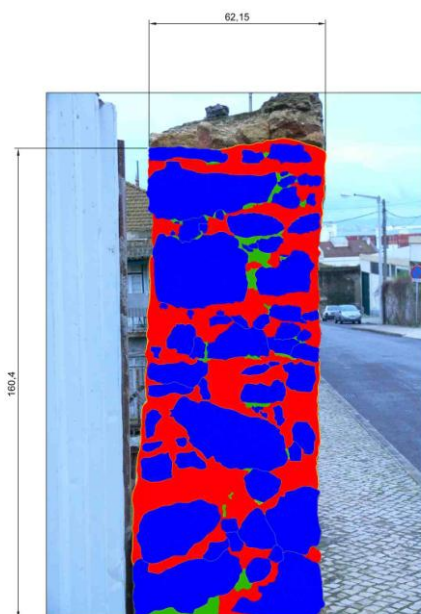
Elementos constituintes da secção transversal da Calçada do Grilo em Lisboa
